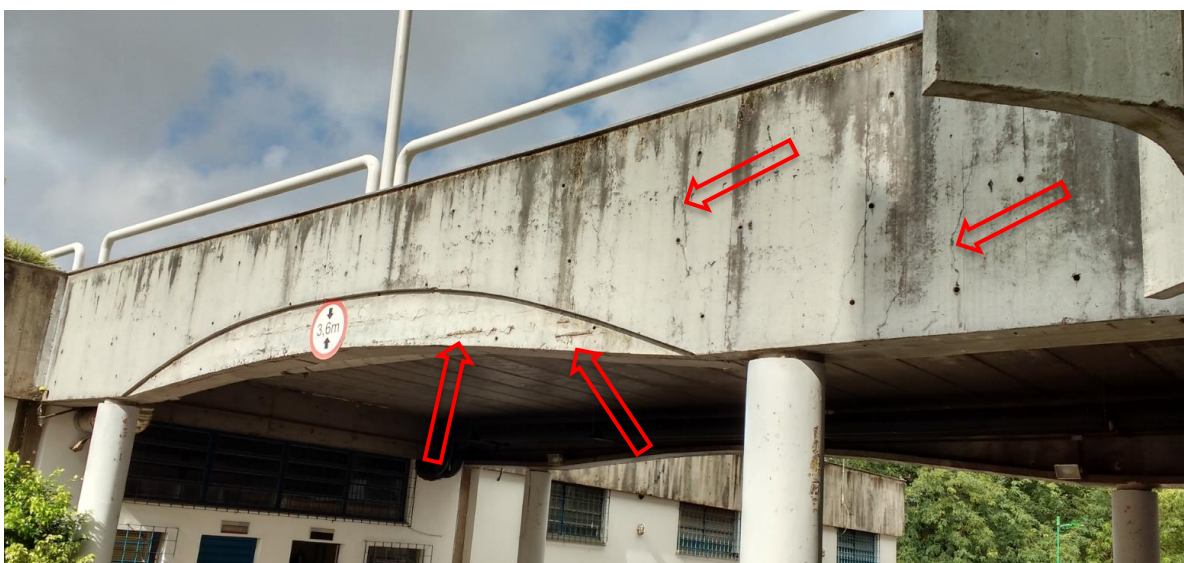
fissuras na face externa das longarinas com exposição de armaduras em alguns pontos.
